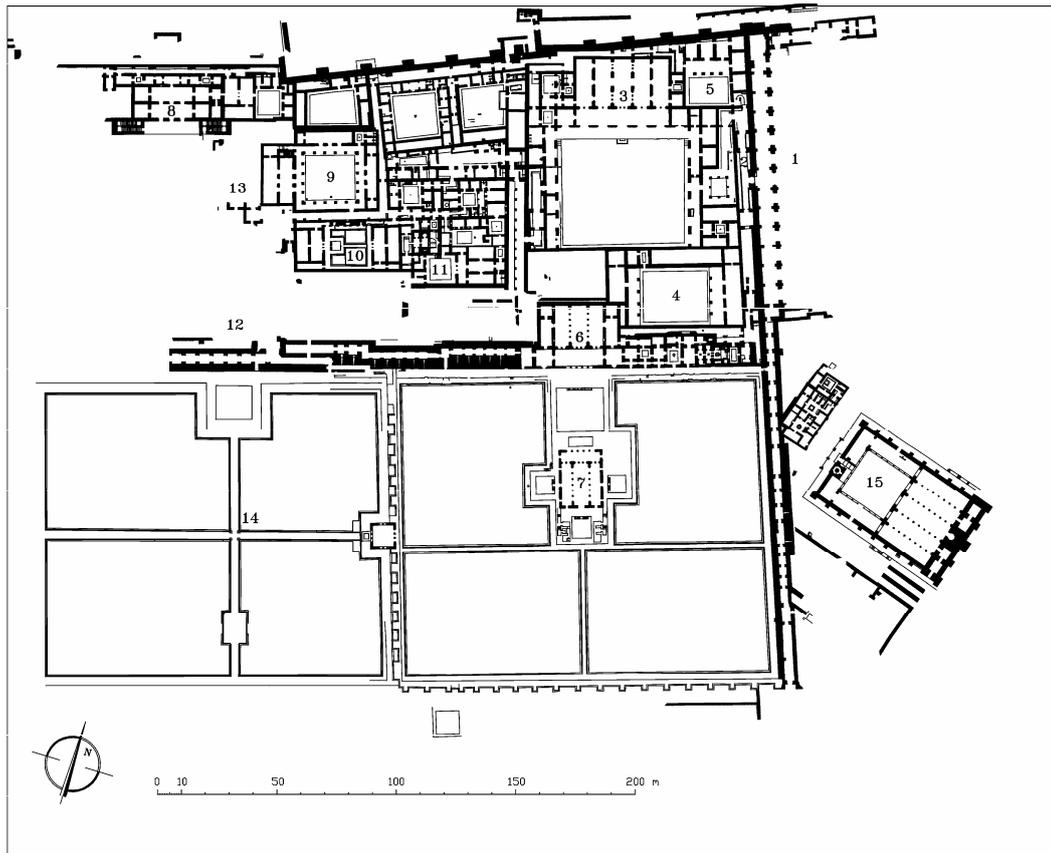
Planta del área excavada del Alcázar de Madīnat al-Zahrā': 1.- Explanada y pórtico de acceso. 2.- Corredores de acceso a la Dār al-Āund. 3.- Dār al-Wuzarā'. 4.- Dār al-Āund. 5.- Casa junto a la Dār al-Āund. 6.- Salón Oriental (Salón Rico). 7.- Pabellón Central de la terraza alta. 8.- Dār al-Mulk. 9.- Patio de los Pilares. 10.- Casa de la Alberquilla. 11.- Casa de Āfar. 12.- Salón Occidental? 13.- Salón de las dobles columnas. 14.- Jardín bajo de crucero. 15.- Mezquita.
